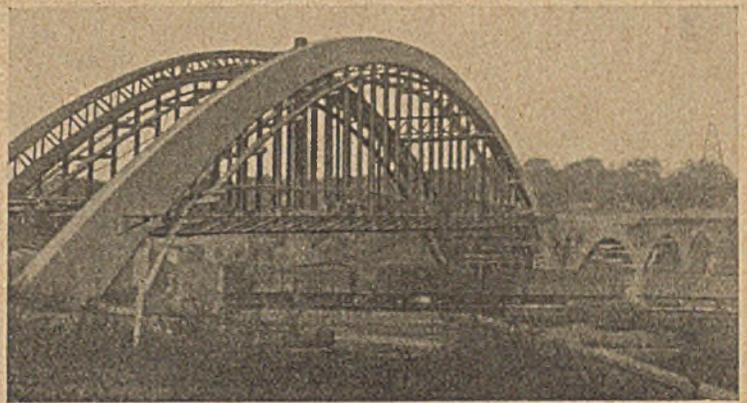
Straßenbrücke in Fitchburg, l = 62,4.
